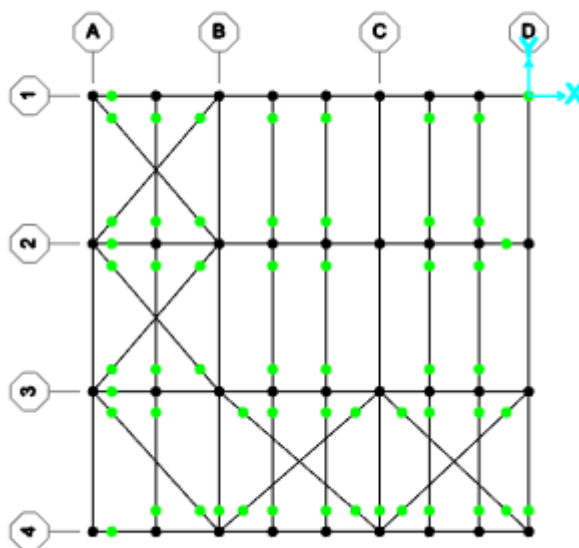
Vista in pianta modello struttura in elevazione – Piano 1 z = 5,5 - rilasci
